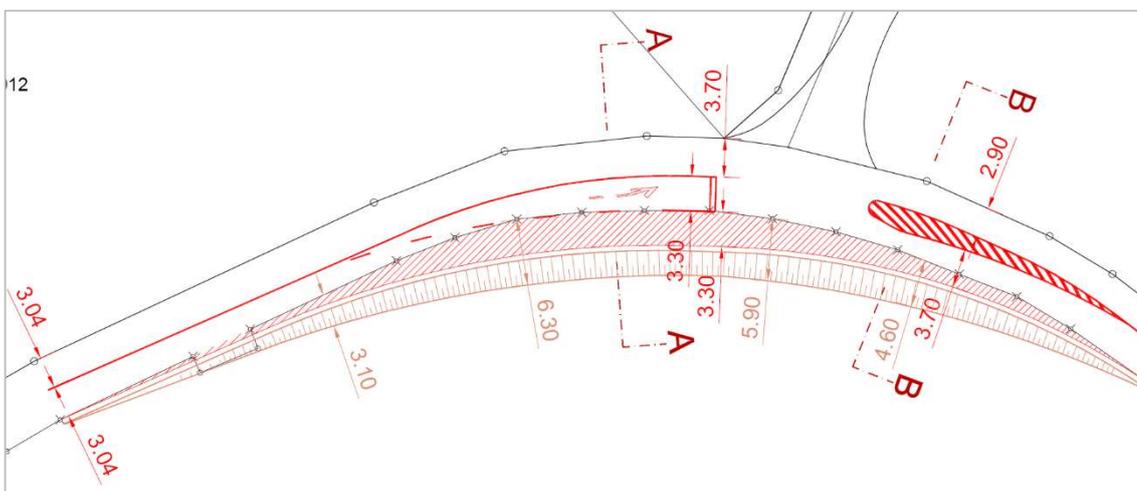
Sezioni trasversali – proposta 2 (cfr. anche allegato)
